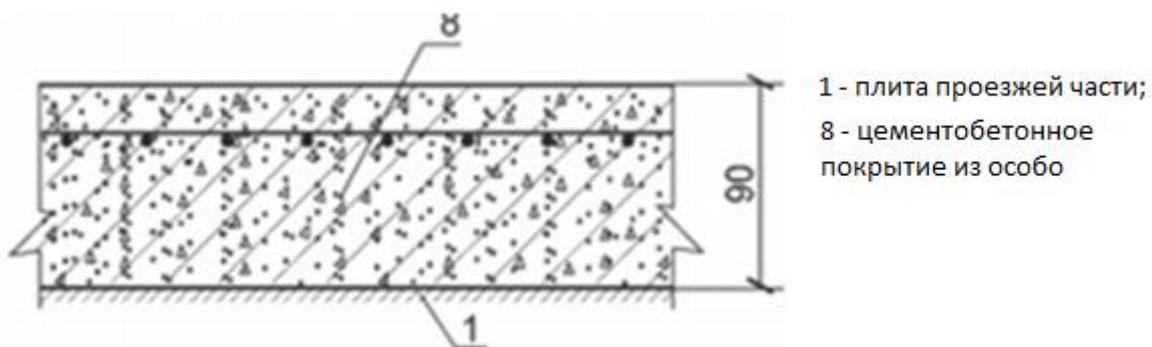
Конструкция дорожной одежды на железобетонной плите с применением цементобетонного покрытия из особо плотного бетона, выполняющего гидроизолирующие функции, или из фиброцементобетона
